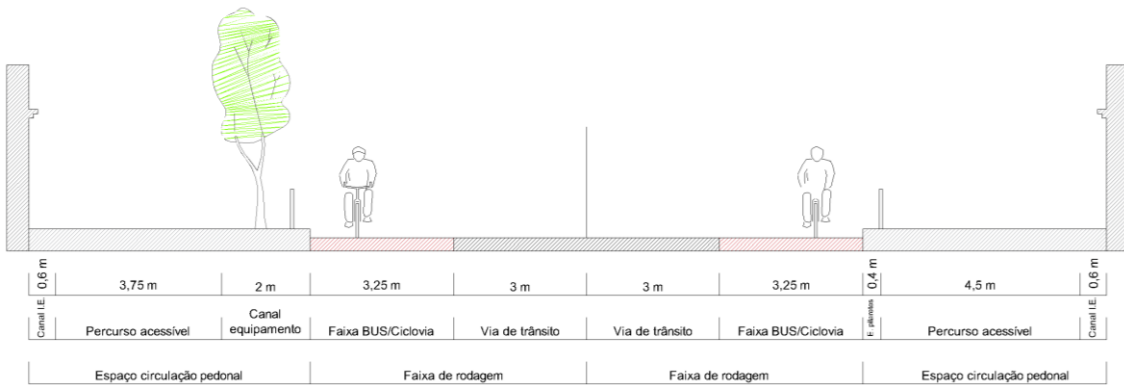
SECÇÃO PROPOSTA E-E'
